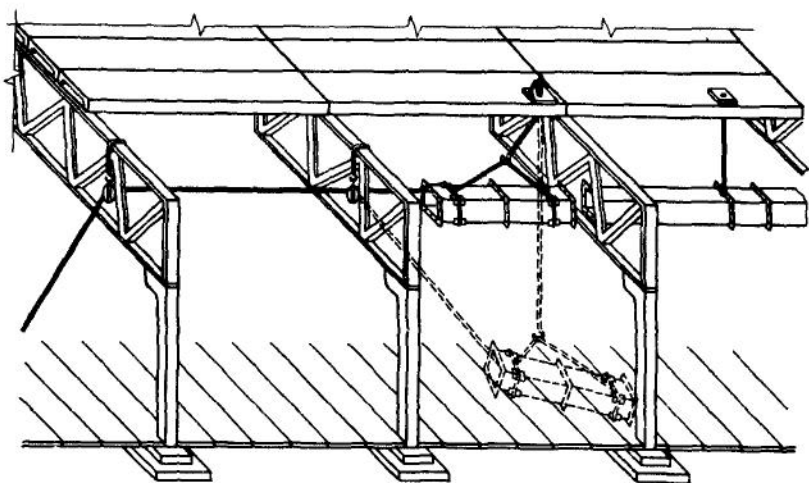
Монтаж воздухопроводов в межферменном пространстве
